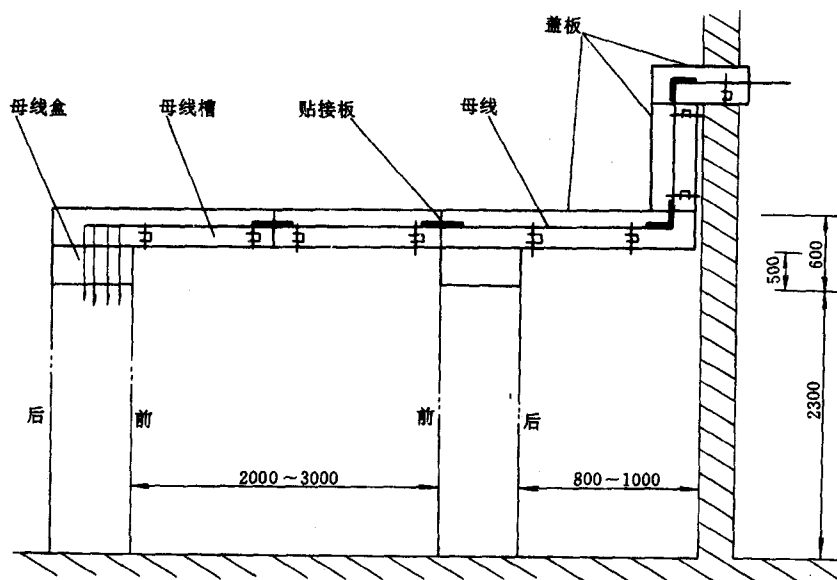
BFC—20 型抽出式低压开关柜典型母线槽安装尺寸及连接方法 (mm)
